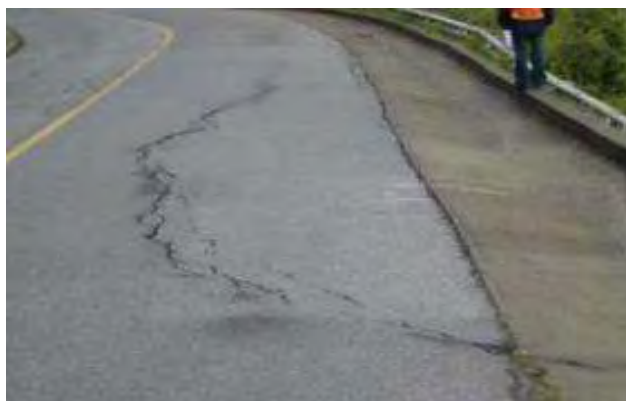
Fisuras Parabólicas o por deslizamiento.
